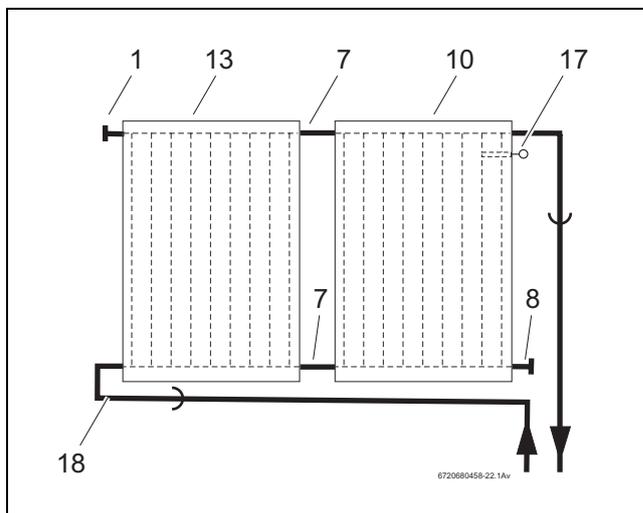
Collegamento idraulico (massimo 10 collettori)
